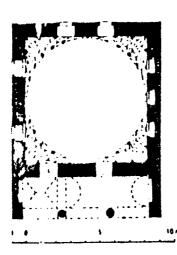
مسقط أفقي لمسجد طاش بقونية (عن: Aslanapa).
